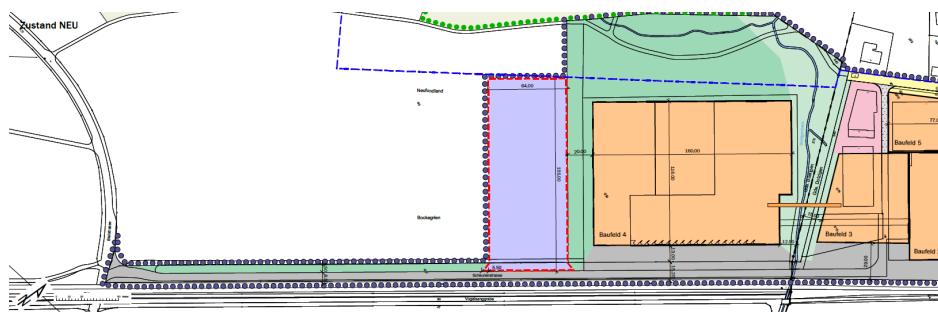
Ausschnitt aus dem Überbauungsplan der Überbauungsordnung «Landi Areal» inklusive neuer Parkierungsanlage für LKW (Stand: 2014)
